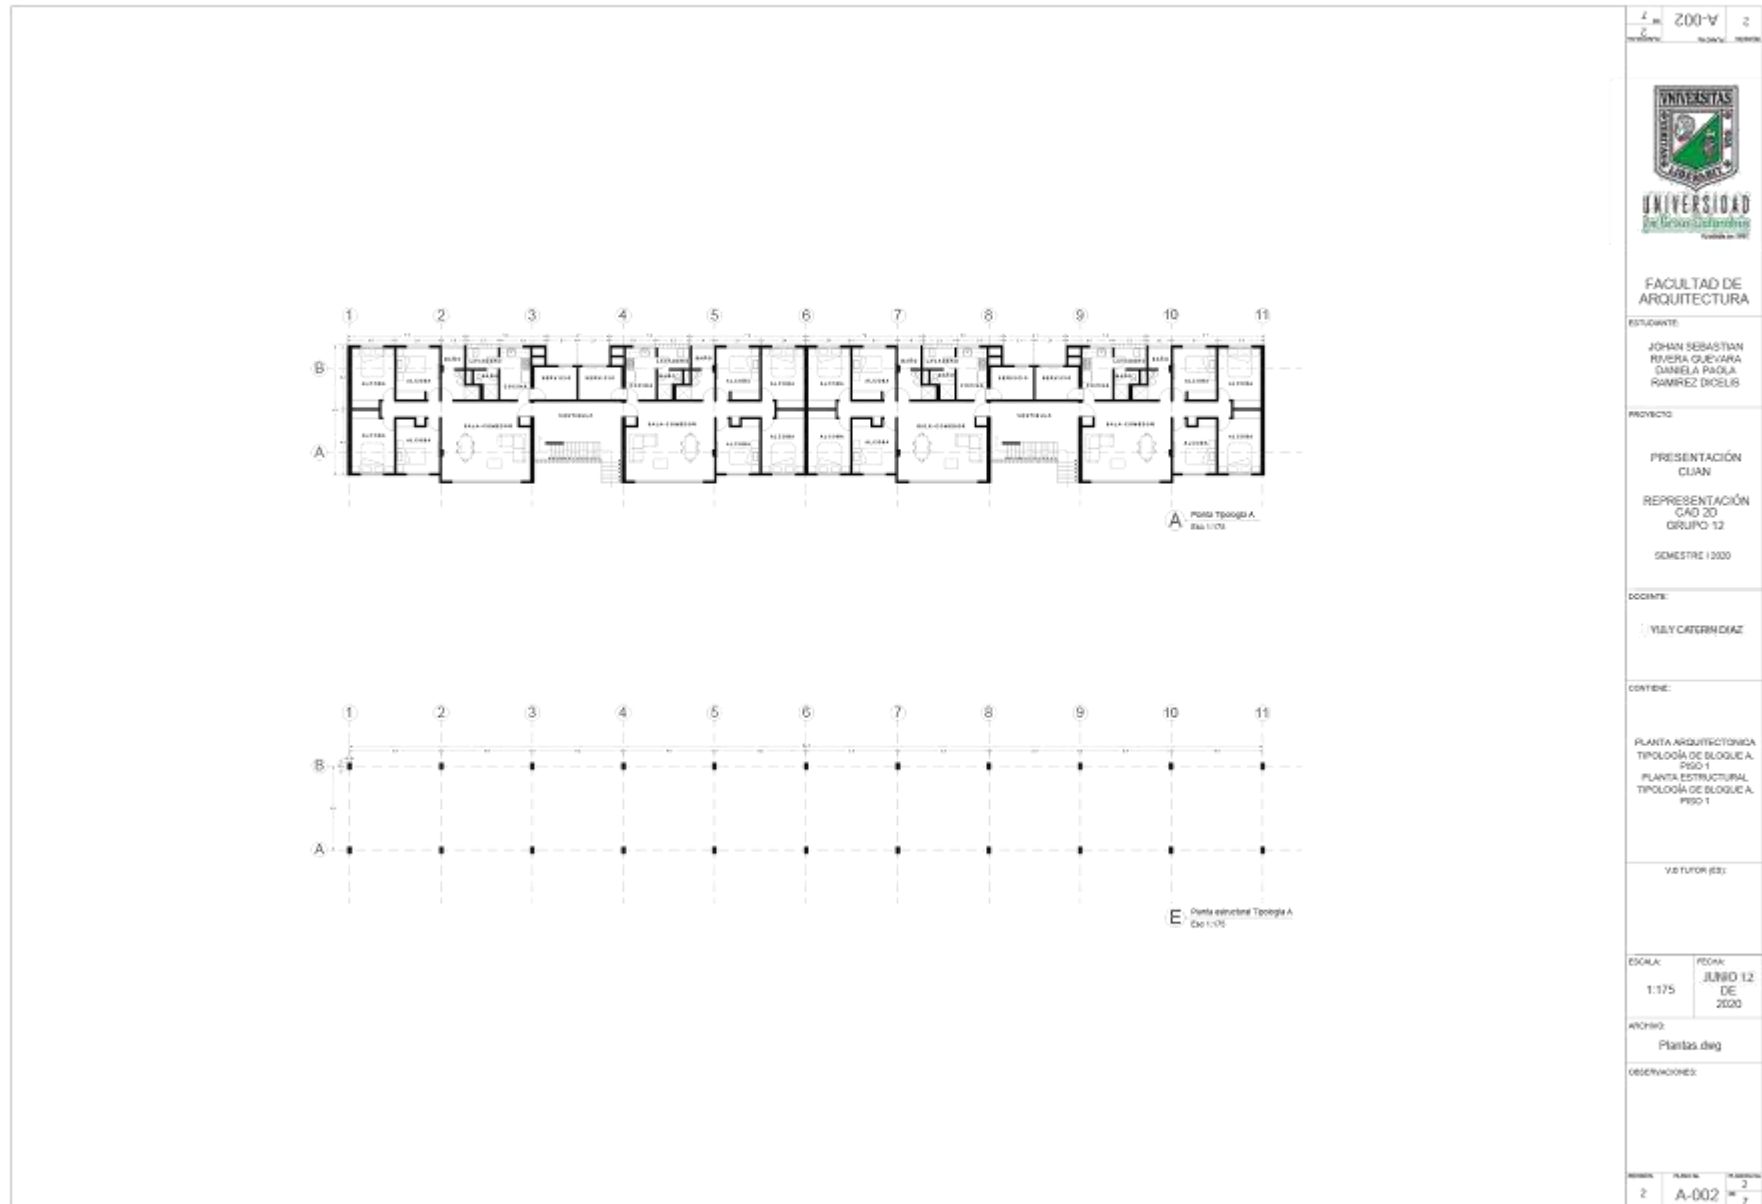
, Planta arquitectónica y estructural bloque Tipología A. Elaboración propia
